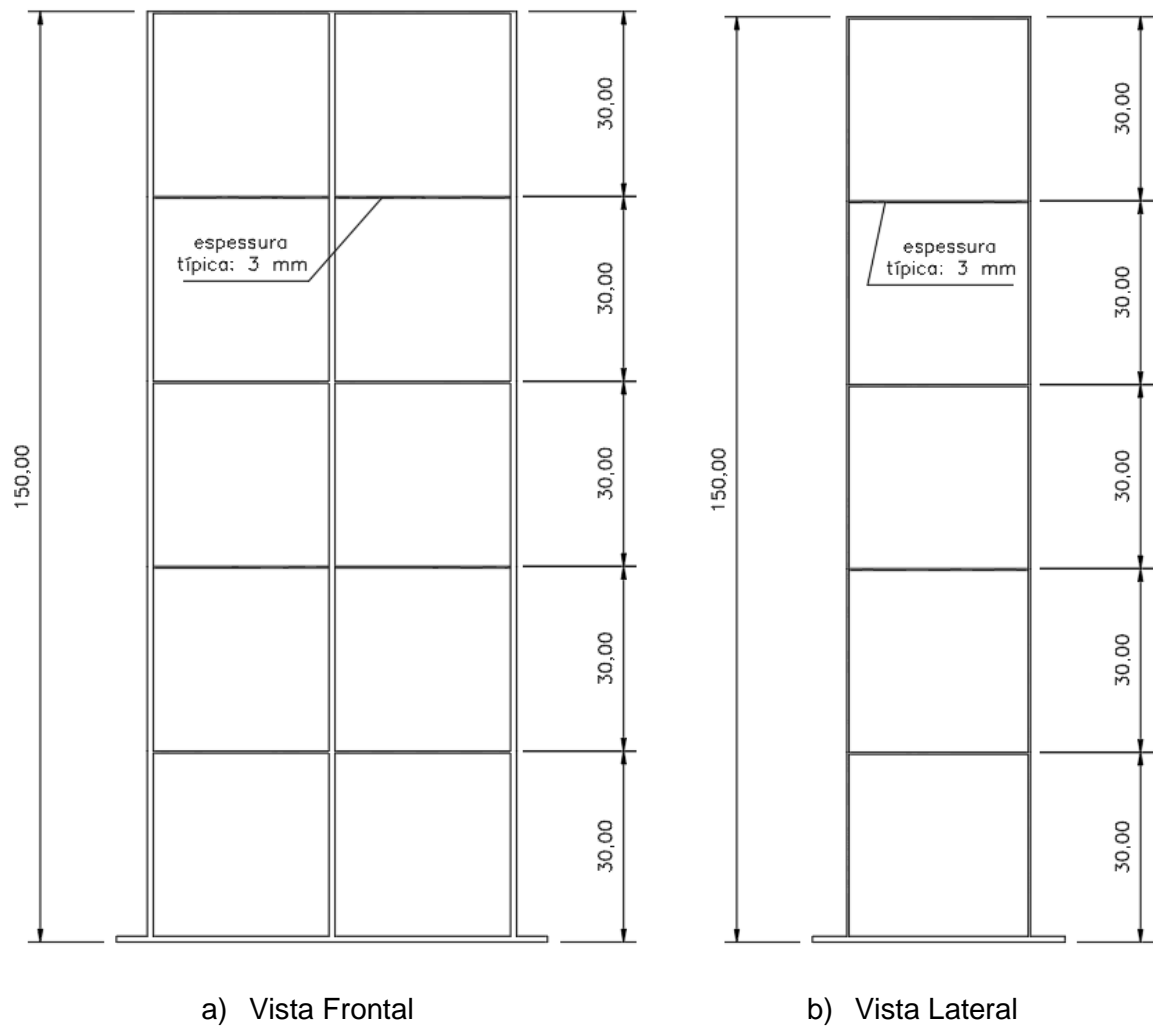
Projeto estrutural. Dimensões: centímetros, exceto onde indicado.
